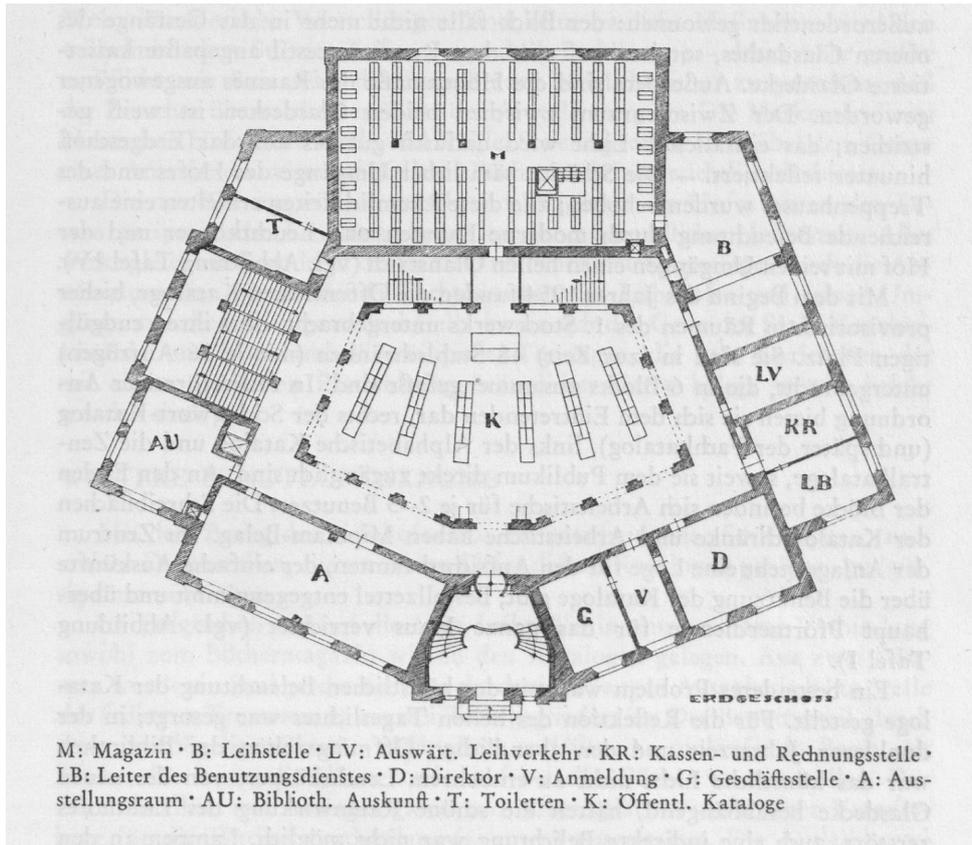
Erdgeschoß-Grundriß des Altbaus mit Raumbeliegung (Stand: 1951/54)
